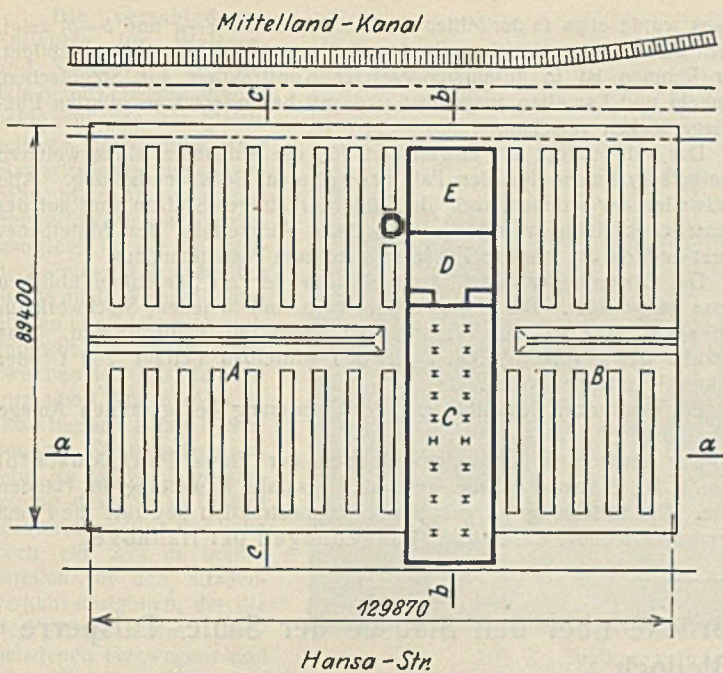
a. Grundriß in Höhe der Obergeschosse.
